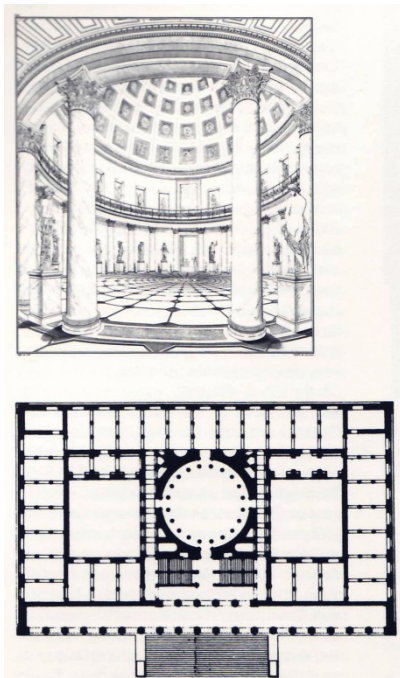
Altes Museum Berlin 1824-28 von *Karl Friedrich Schinkel*; Rotundenperspektive und Grundriss 1.OG;
